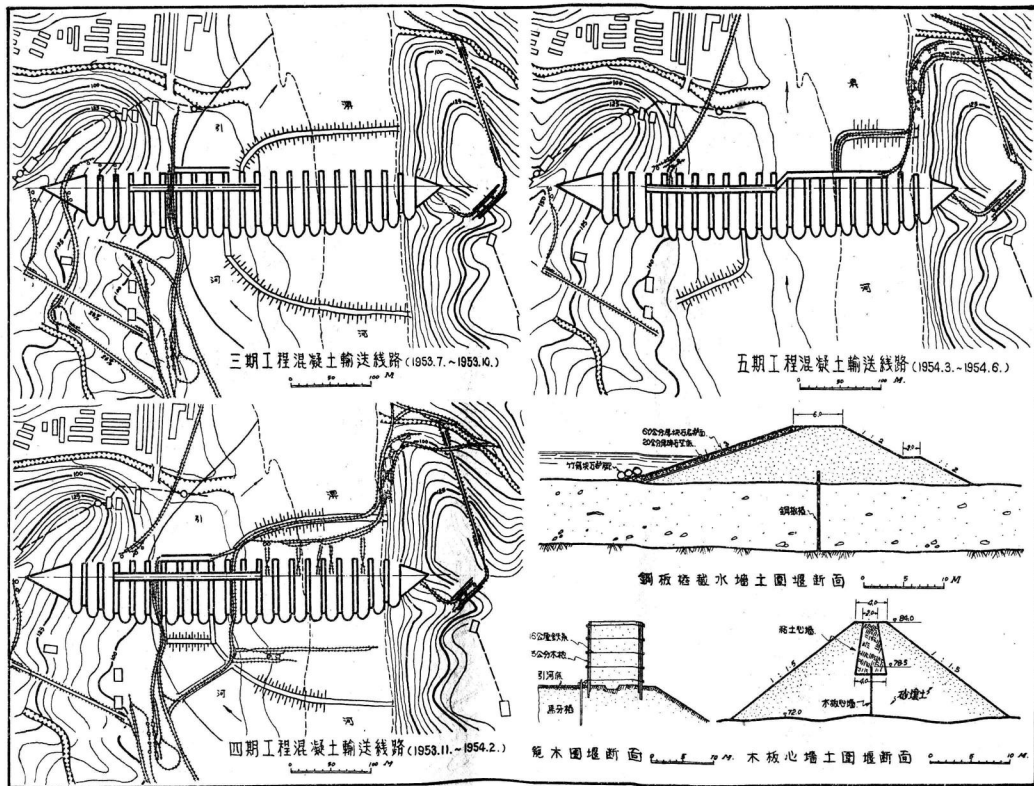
4. 佛子嶺水庫工程施工總平面圖及壩區混凝土輸送布置圖
